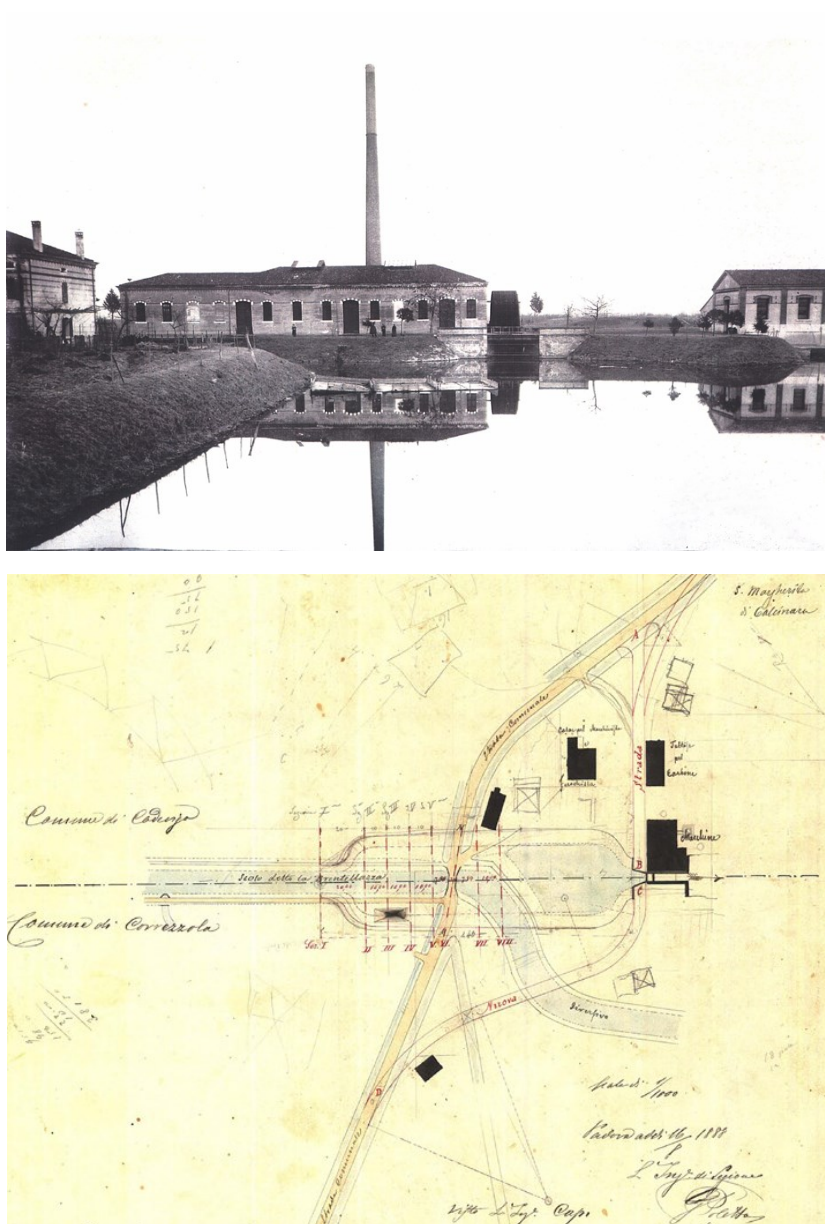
Panoramica e planimetria dell'impianto Idrovoro Santa Margherita nel 1888
